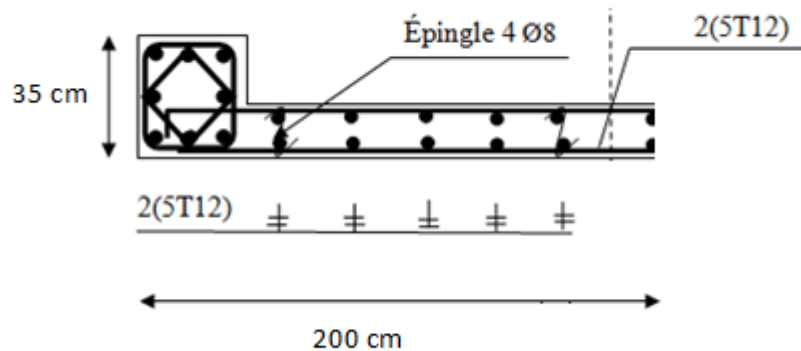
Schéma de ferrailage du mur voile (Type 2)
